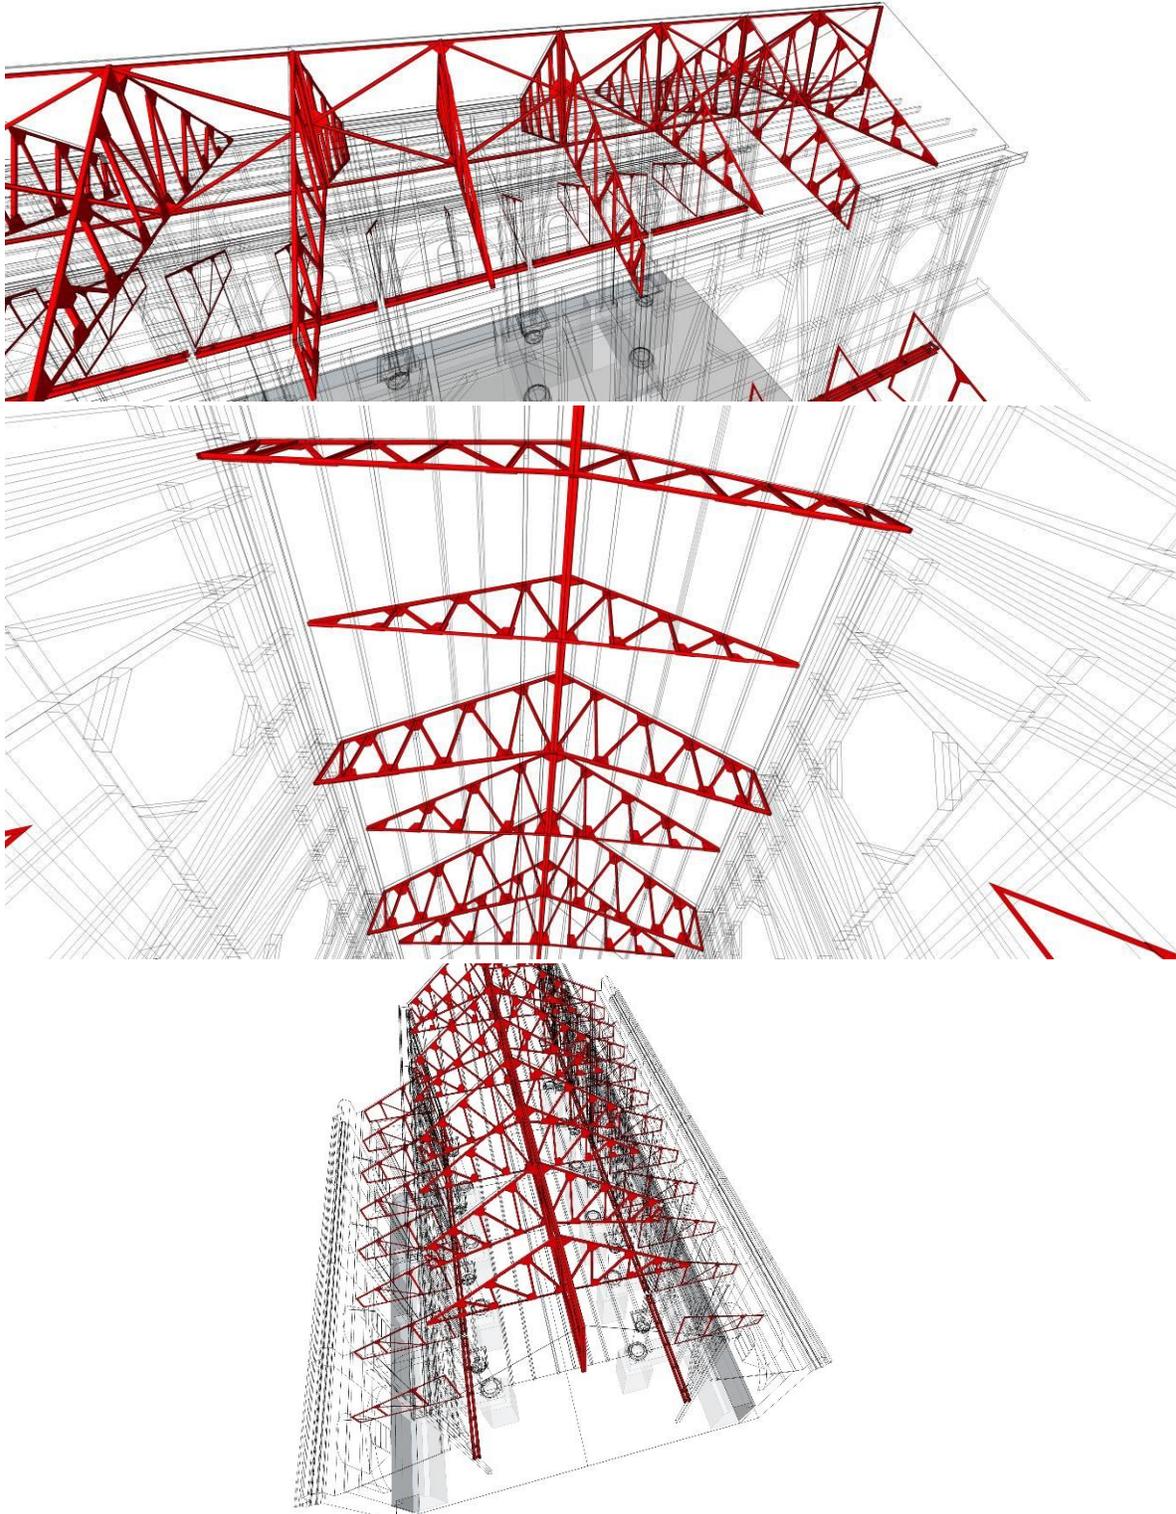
Esquemas en perspectiva de estructuras metálicas en naves. Elab. Propia.
